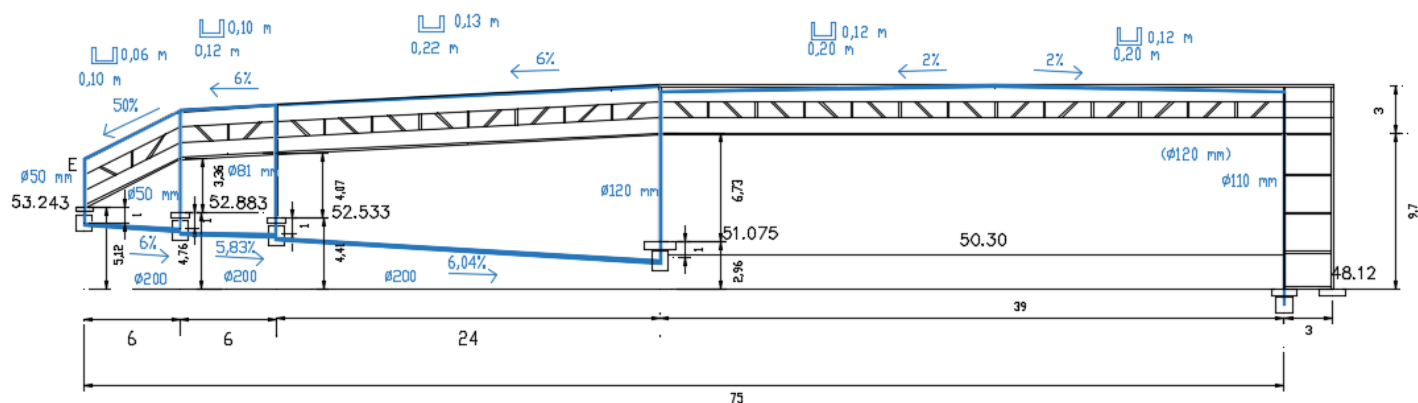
Vista longitudinal dos elementos de drenagem de águas pluviais
